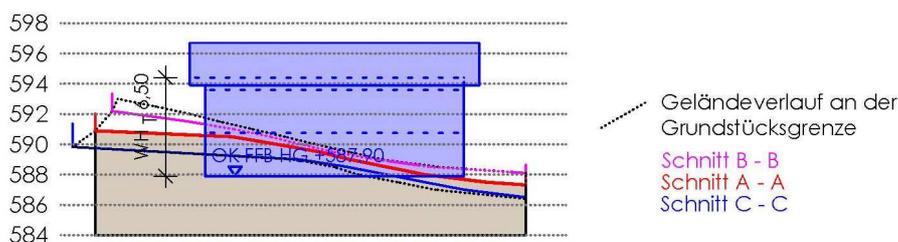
Betont rechteckiger Baukörper mit hangseitig integrierter Garage.
